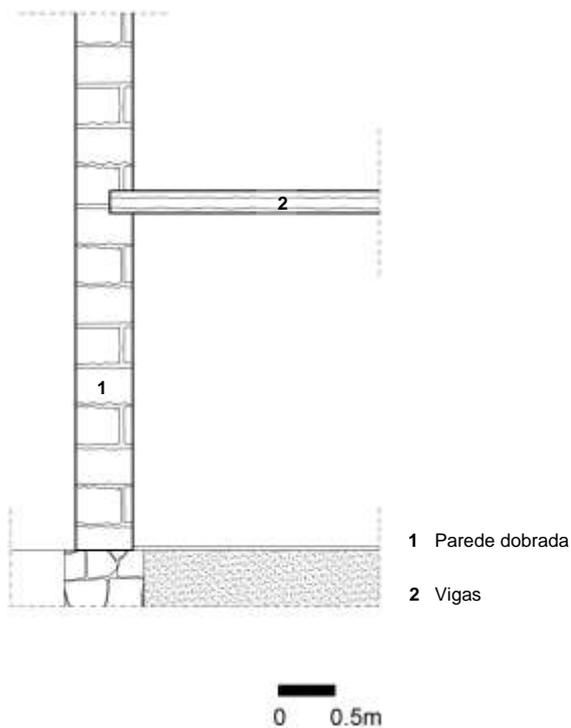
Pormenor de corte longitudinal de uma parede tradicional dobrada, a toda a sua altura; e viga assente na pedra. (Ilustração nossa, 2021)
